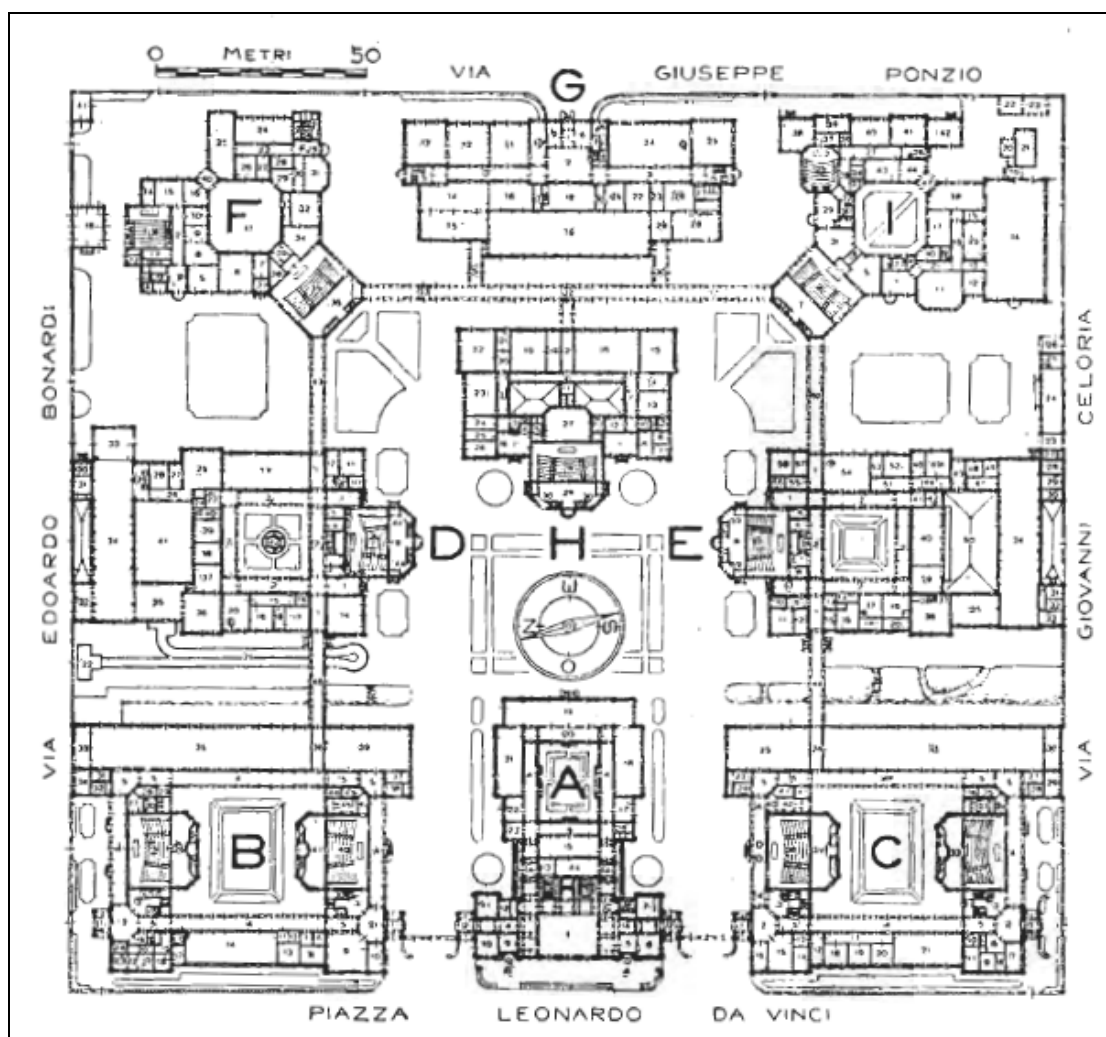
Planimetria generale del piano terreno del Politecnico
